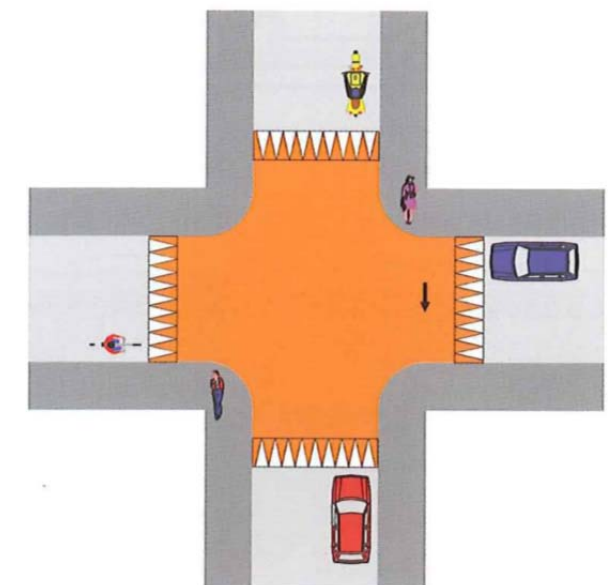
Exemple d'implantation d'un plateau traversant (Source CERTU)
